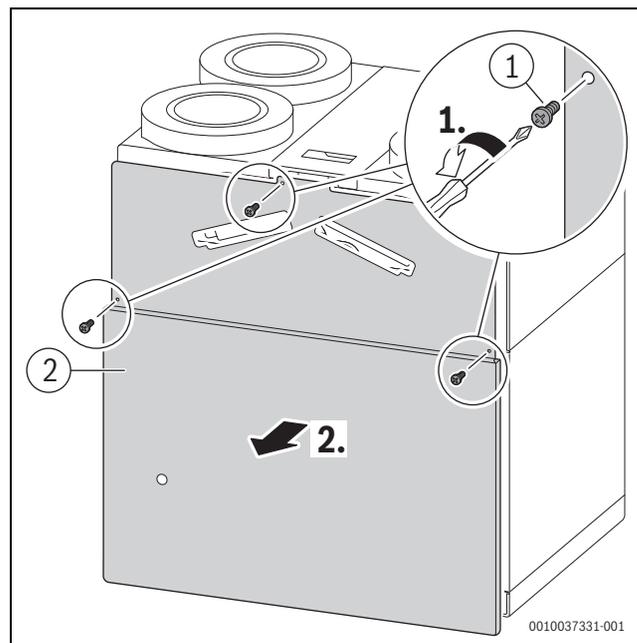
Schrauben lösen und Abdeckblende des EPP-Grundkörpers (Metall) abnehmen
